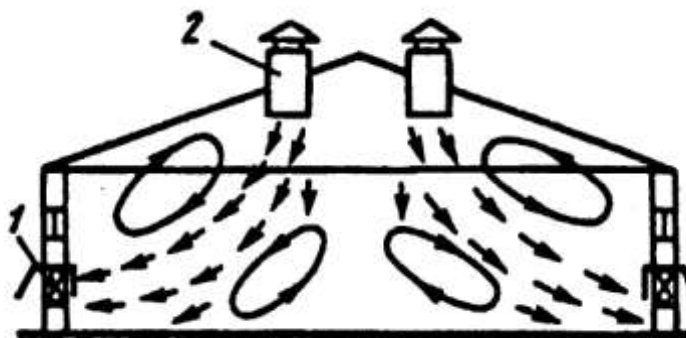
Вытяжная вентиляция с настенными вентиляторами: 1 - настенные вентиляторы; 2 - приточные шахты.
